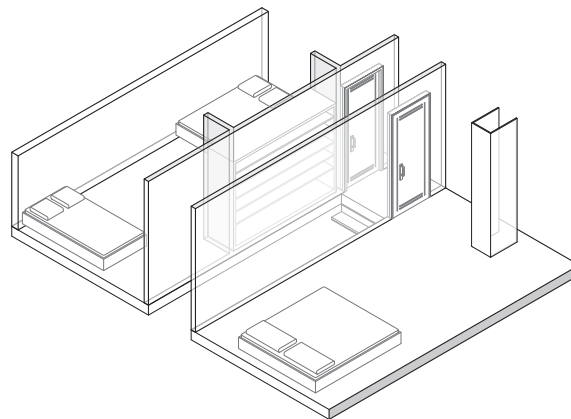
Planta baja departamento dúplex Tipo B para cuatro personas
